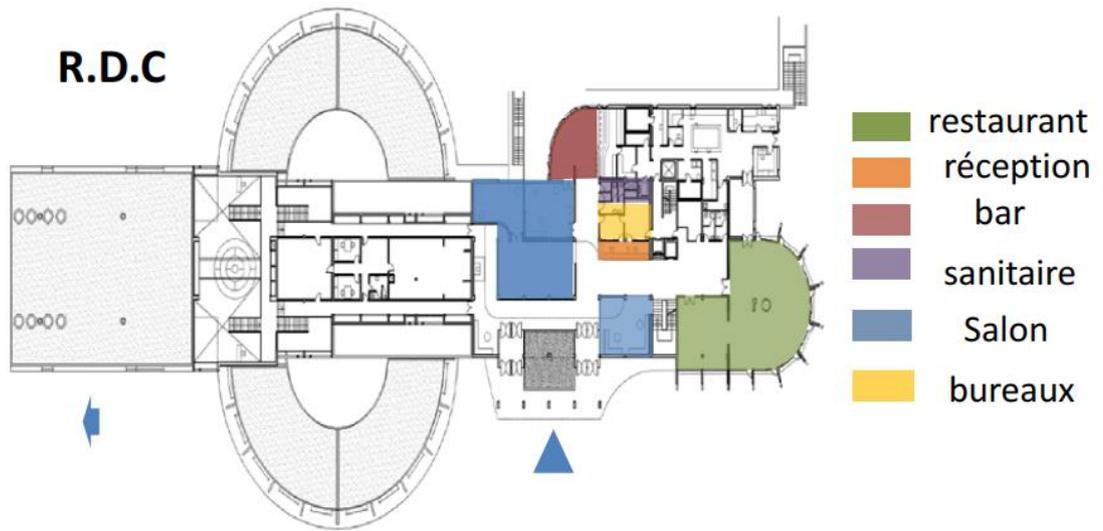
43: Plan RDC (google image modifier par l'auteur 2019)
